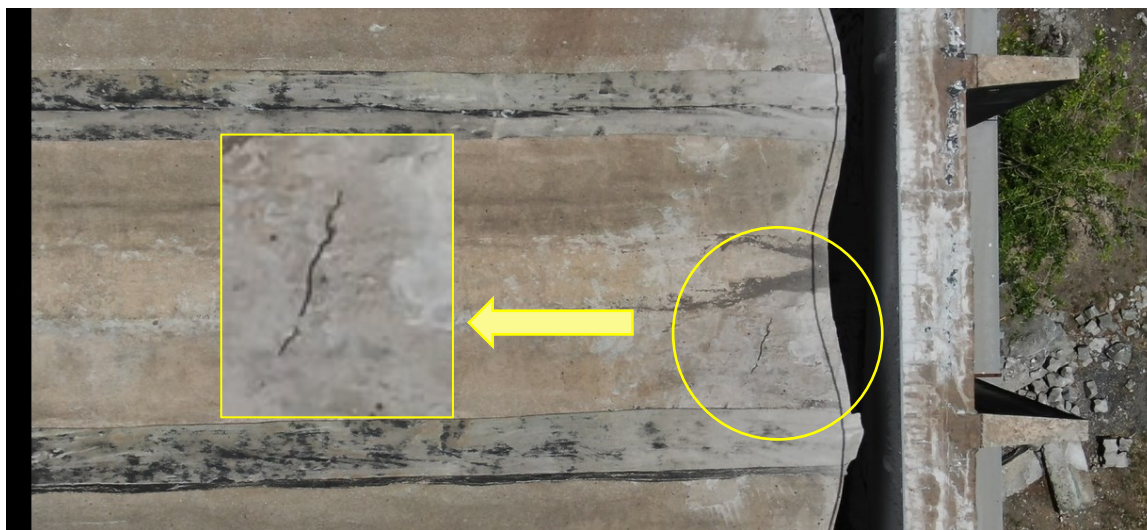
Fissura na área superficial da telha em concreto;
